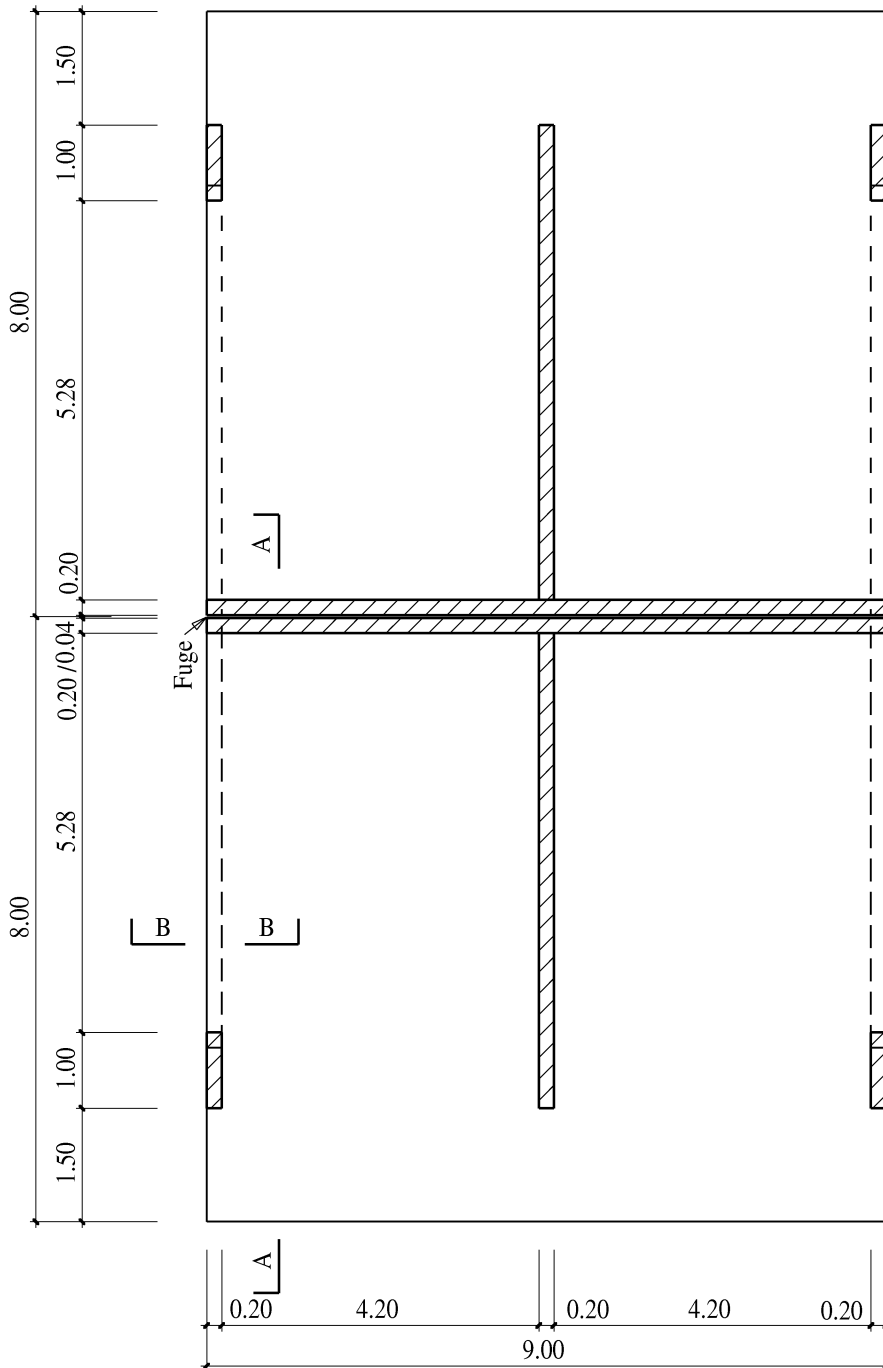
(a) Grundriss Stahlbetonplatte zu Aufgabe 2a) bis c)
